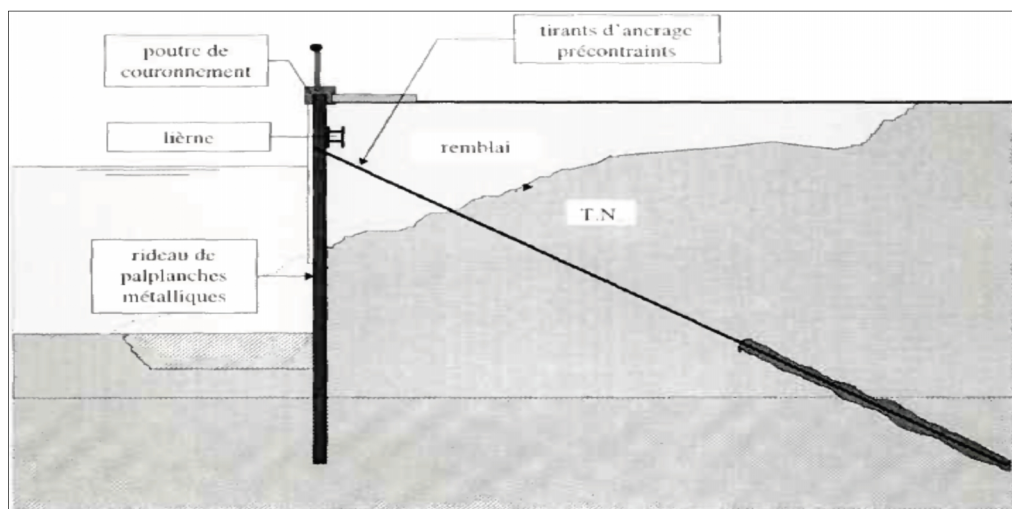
Constitution d'un soutènement de rive en palplanches
